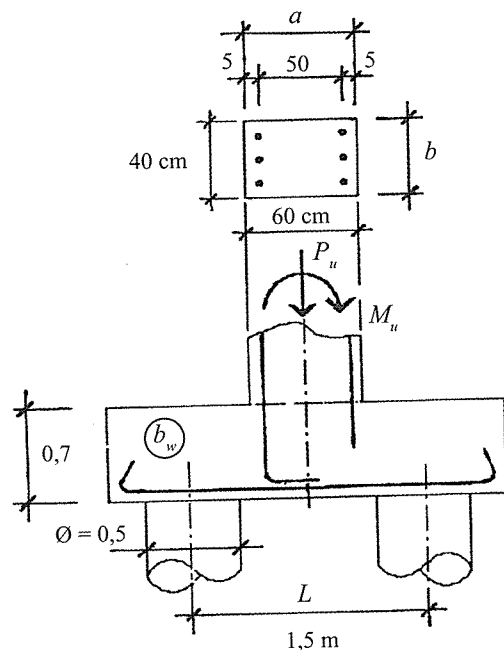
Élévation de la semelle sur pieux et schéma des armatures principales.
